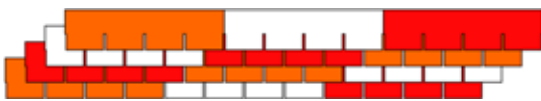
Схема чередования фасадной плитки. Каждый цвет соответствует отдельной упаковке фасадной плитки.
